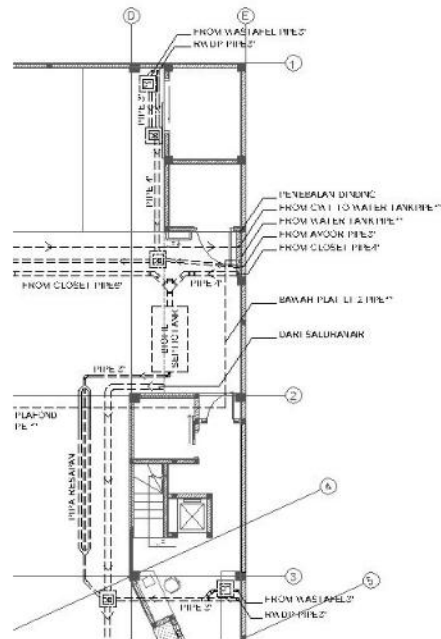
Potongan Rencana *Ground Water Tank*)
